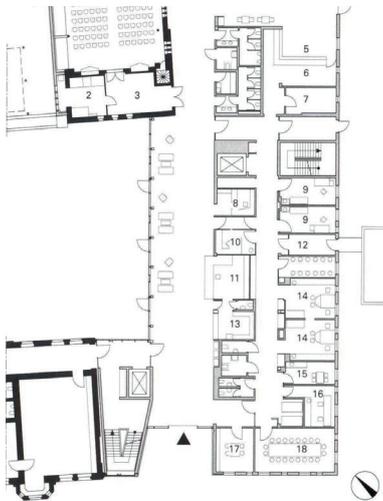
St. Alexius-/St. Josef-Krankenhaus in Neuss, Grundriss Eingangsbereich
